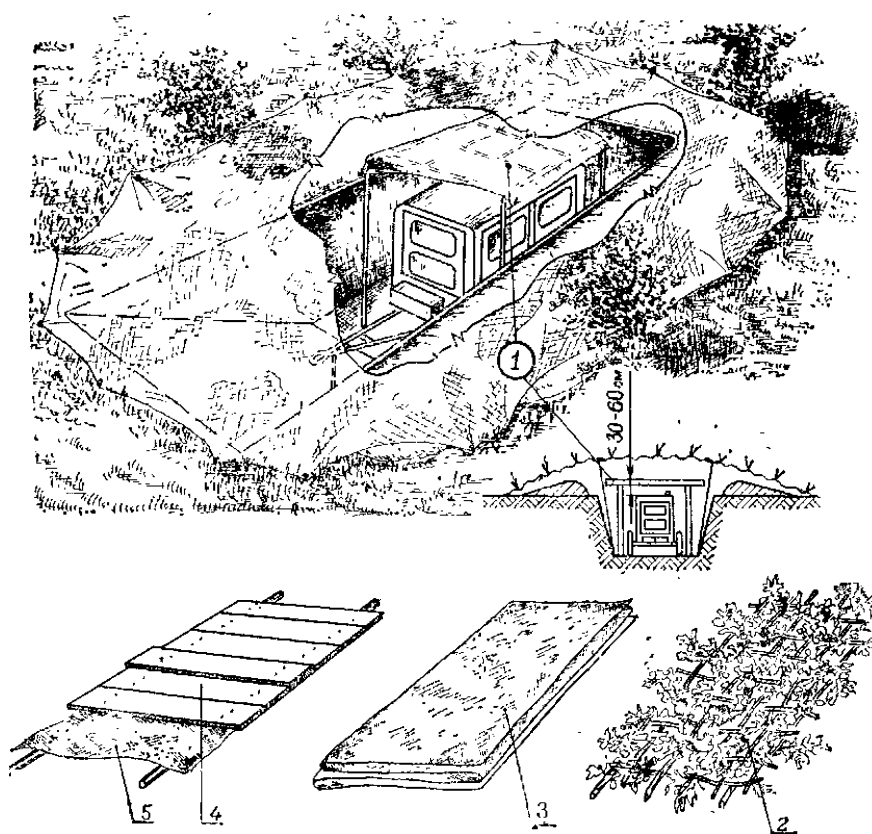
Маска-перекрытие с тепловым экраном:
